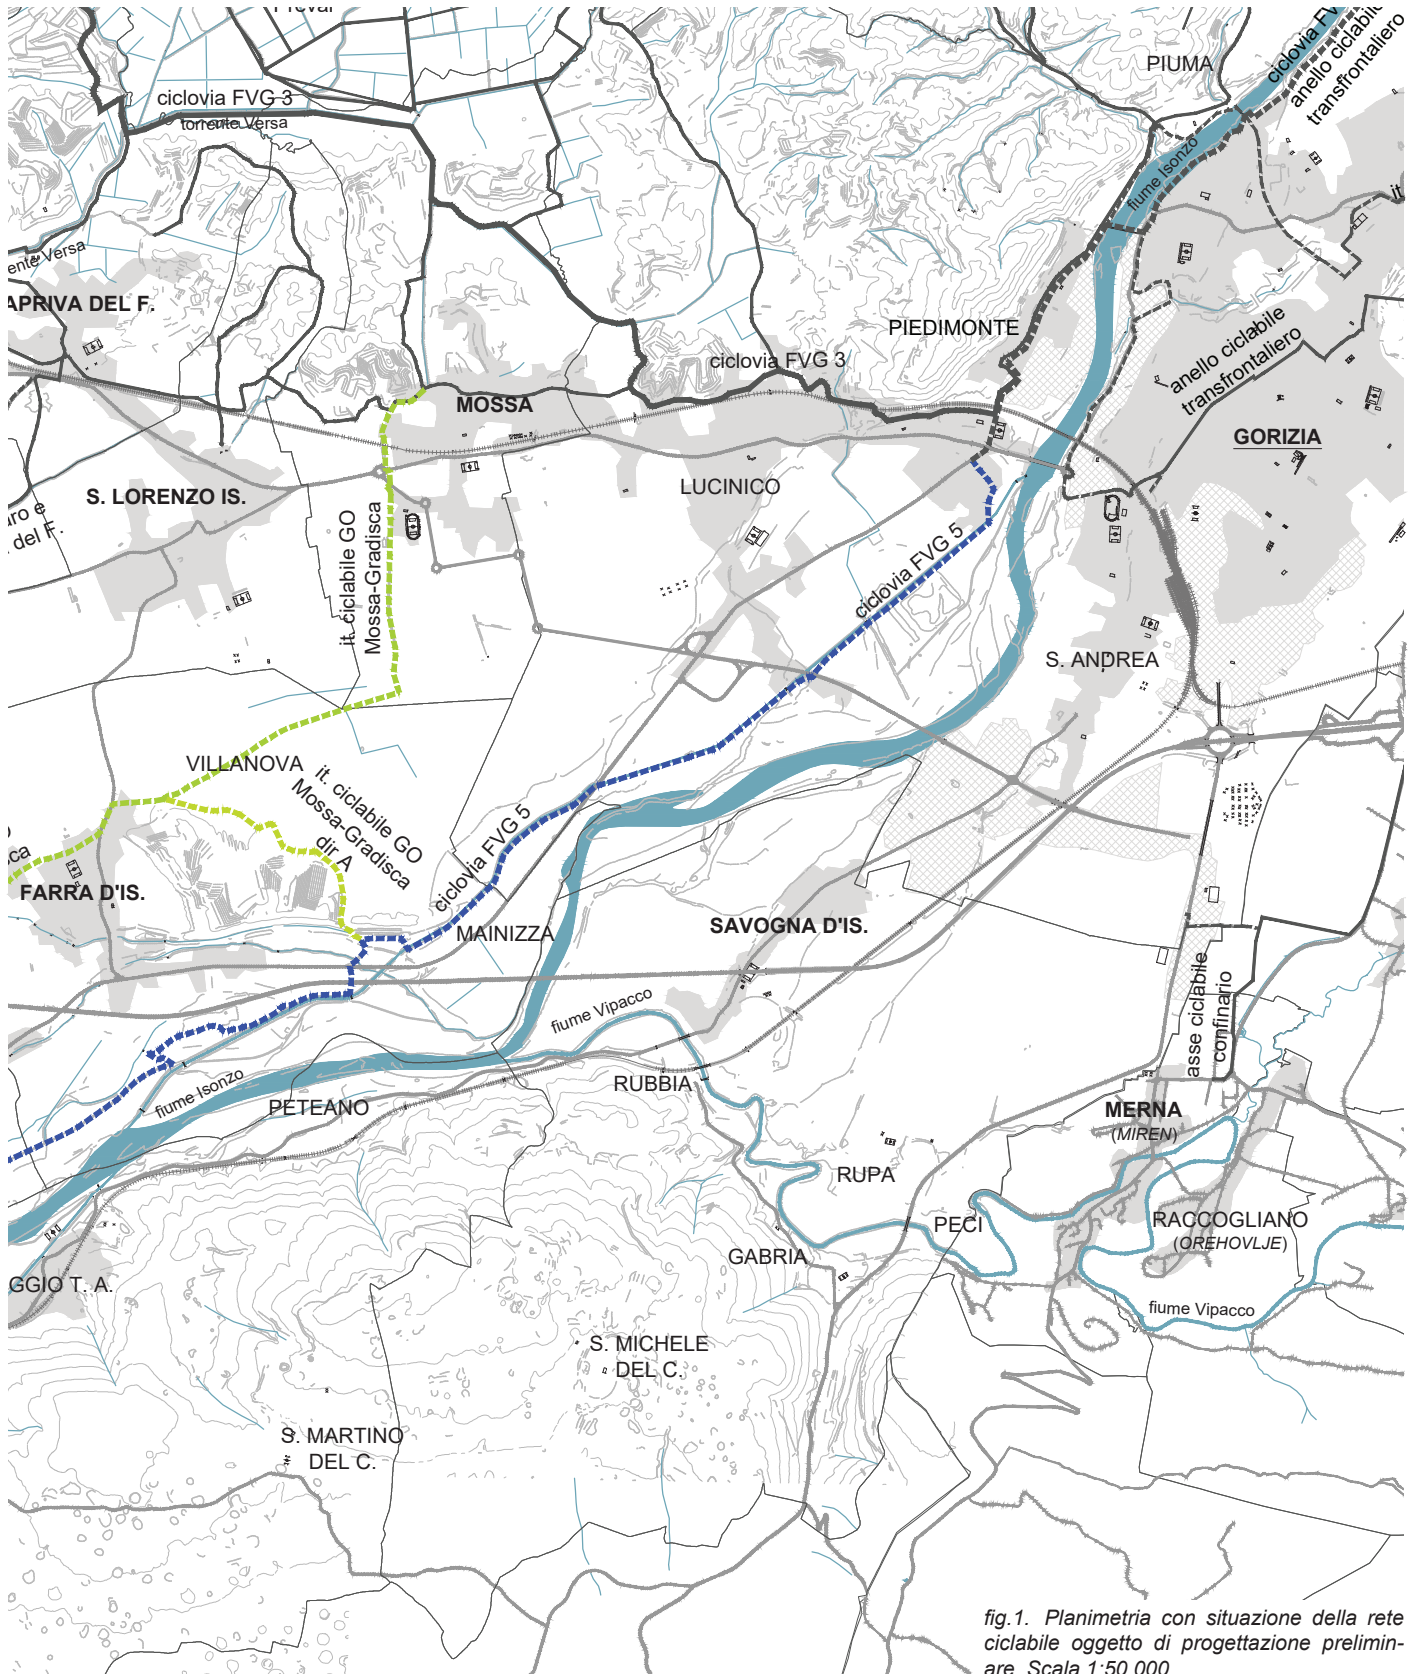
Planimetria con situazione della rete ciclabile oggetto di progettazione preliminare. Scala 1:50.000.
